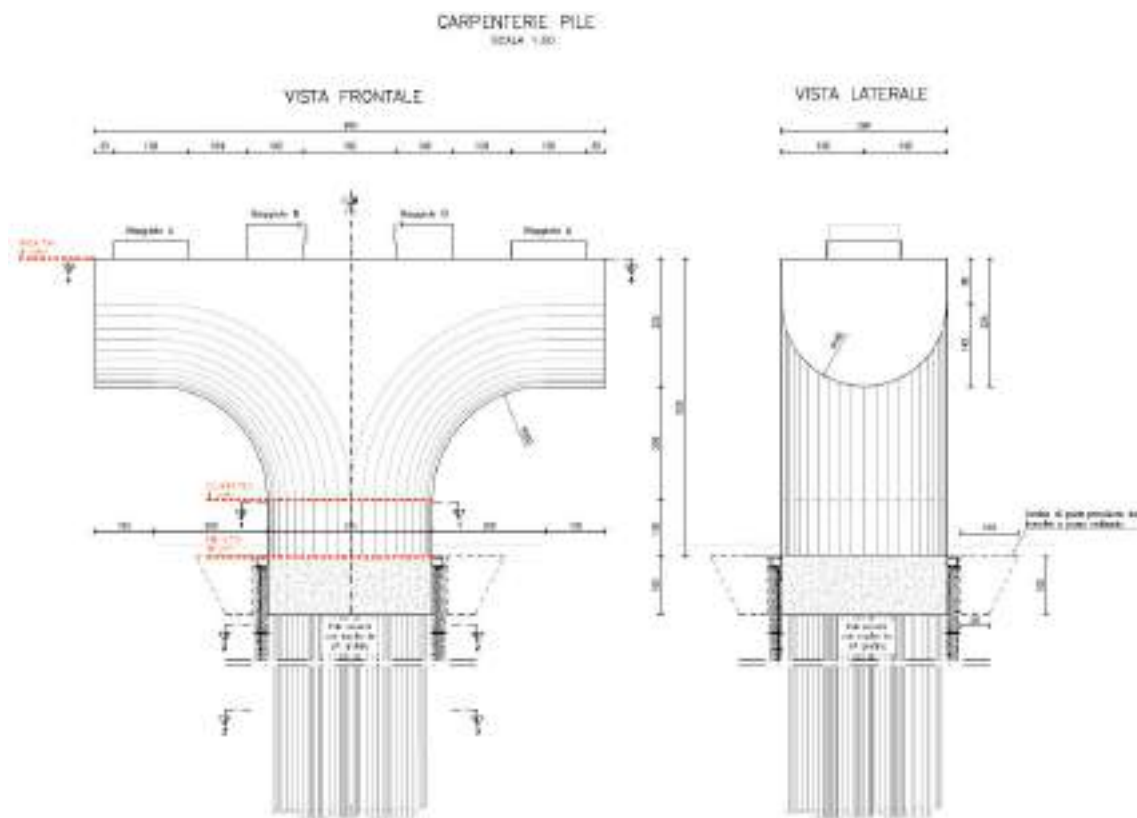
Carpenterie delle pile: elevazioni in vista frontale e laterale.
